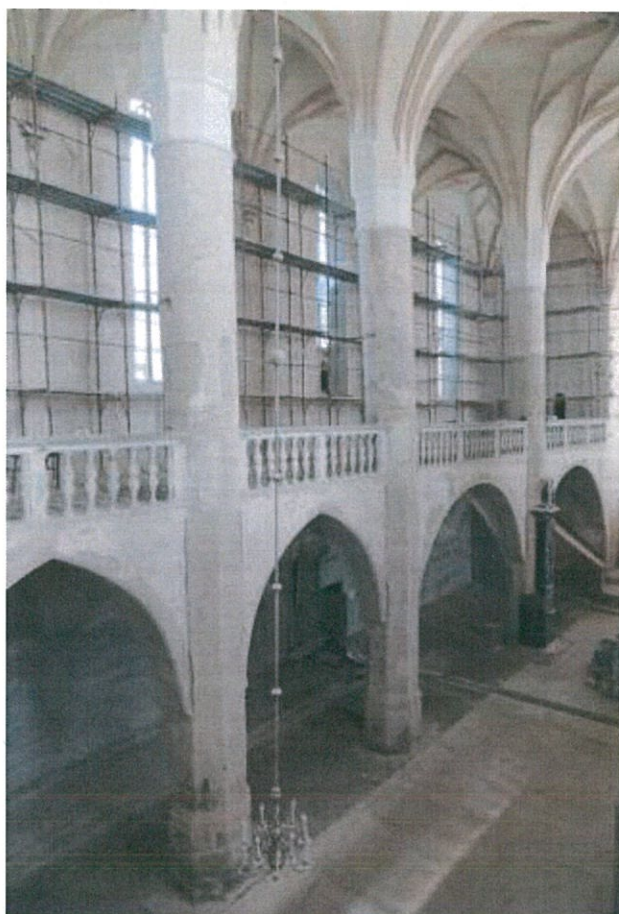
Vedere generală a stâlpilor după decaparea tencuielii
